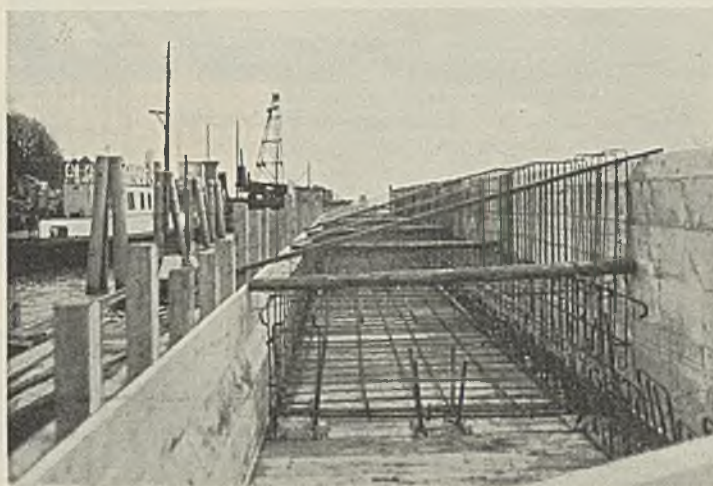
Schalung und Eisenbewehrung der Platte und Brüstung der Eisenbetonmole.
